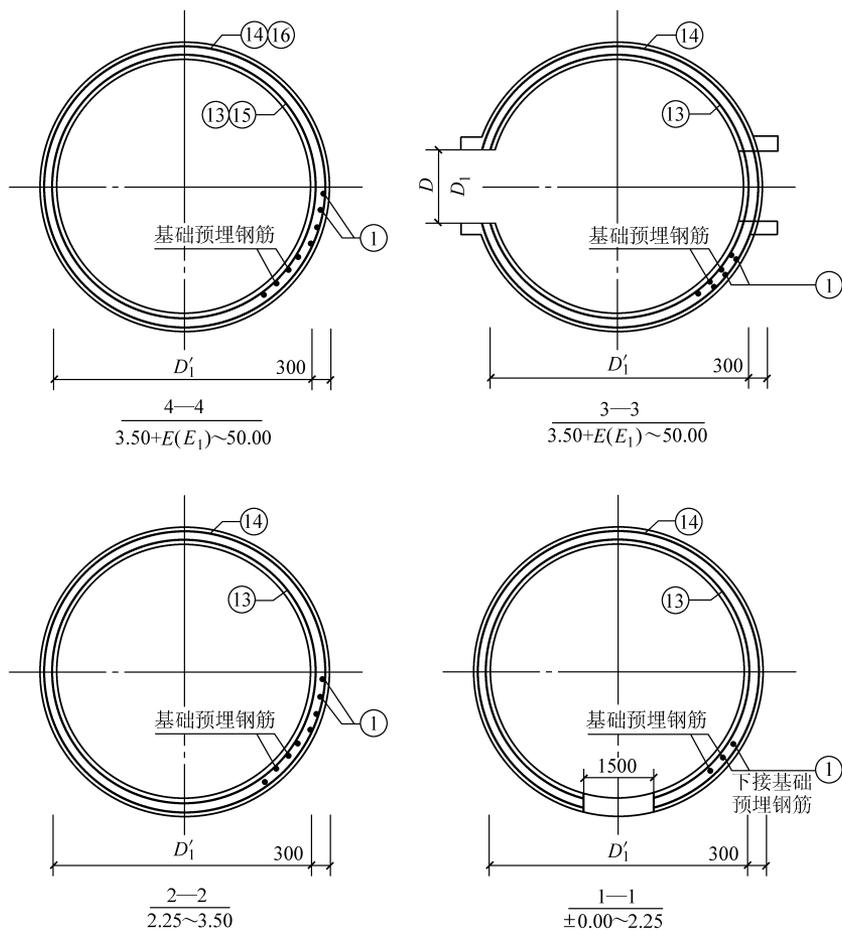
80m 烟囱筒壁配筋断面图 (1-1 ~ 4-4)
